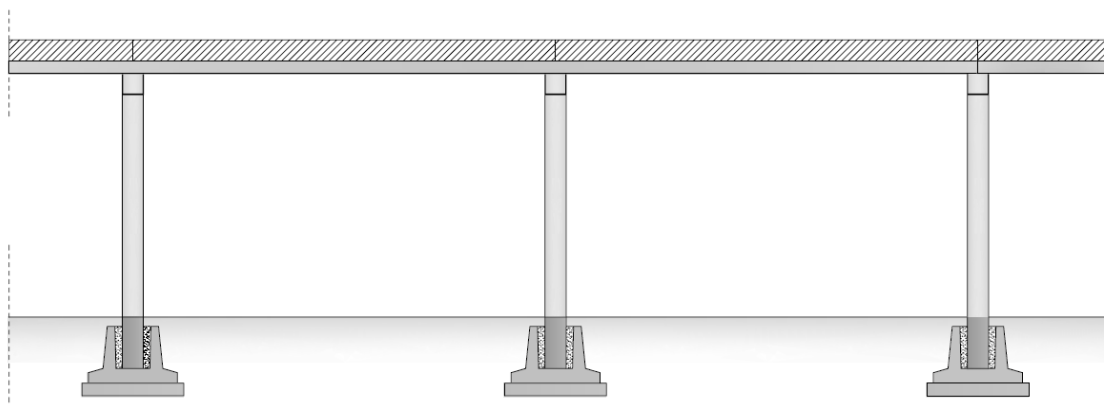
Exemplo de cobertura plana com viga plana em R [12]
